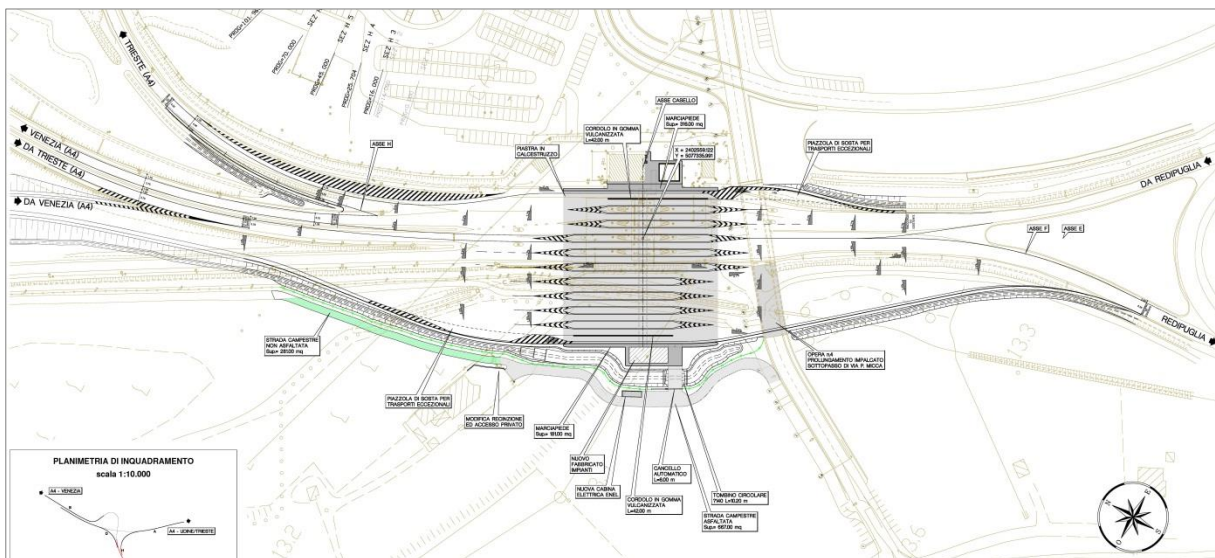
Planimetria allargamento piazzale di stazione e casello.
